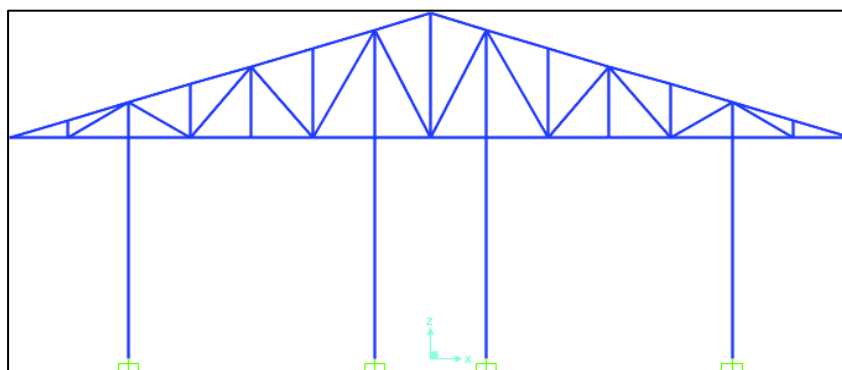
Cercha reticular –Tijeral metálico (Fuente: Elaboración propia)
